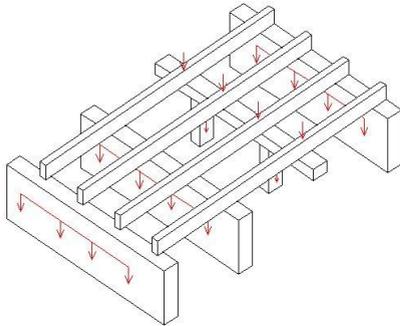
Esquema estructural planta baja. 2014. Propia.
